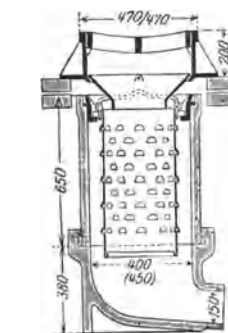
Straßeneinlauf ohne Geruchsverschluß
